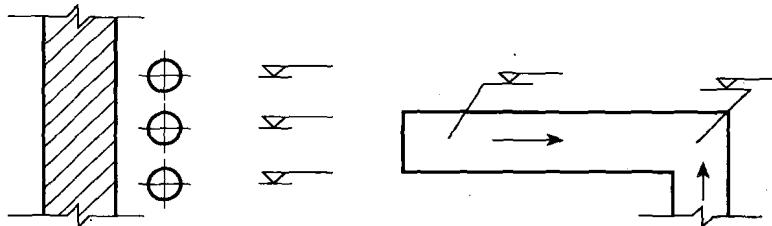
剖面图中管道标高的标注 图 1-3 平面图中管沟地坪标的标注
